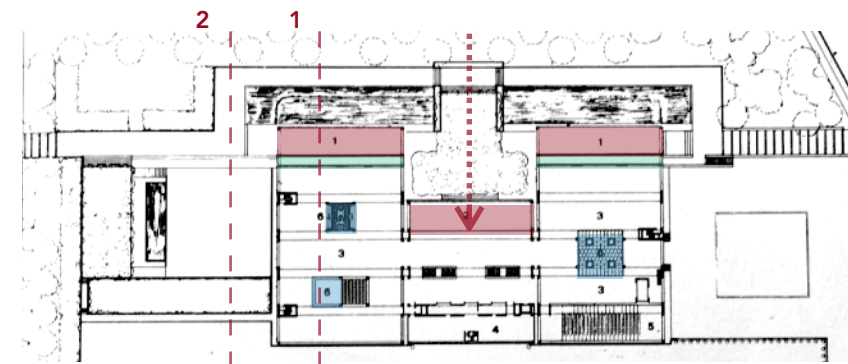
Museo de Arte de Kimbell. Planta. En azul los patios los patios interiores, en rojo las bóvedas exteriores cubiertas y en verde los pozos de luz. La fecha indica el acceso y las líneas las secciones.
